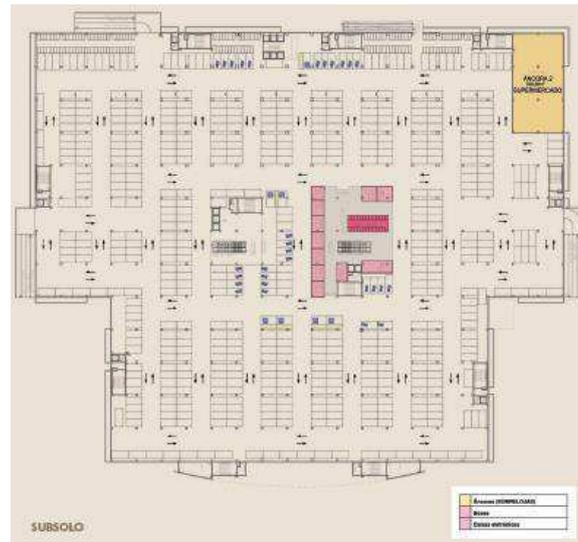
PLANTA BAIXA DO SUBSOLO (P0)
